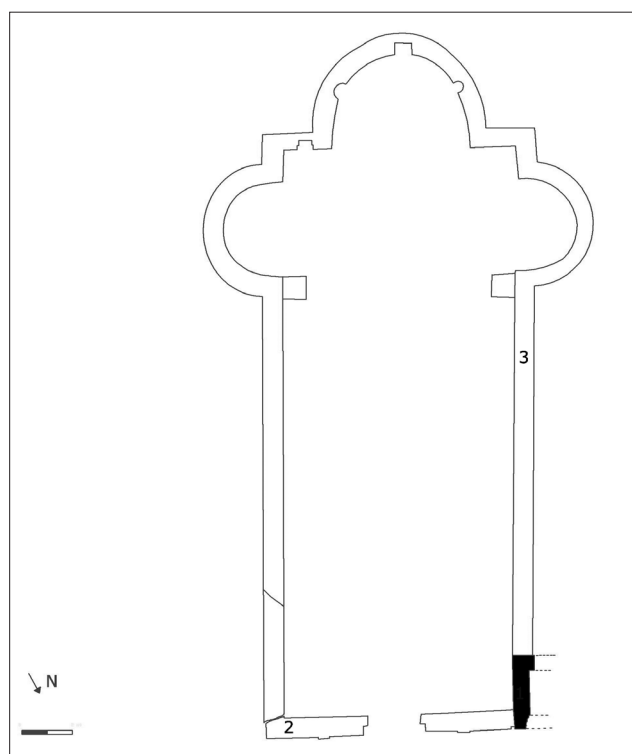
Pianta dell'edificio con localizzazione del paramento Tipo I.
